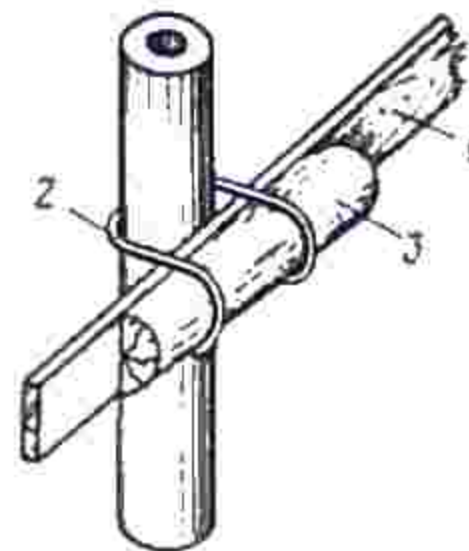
Приспособление для удержания железобетонных стоек при установке рамы
